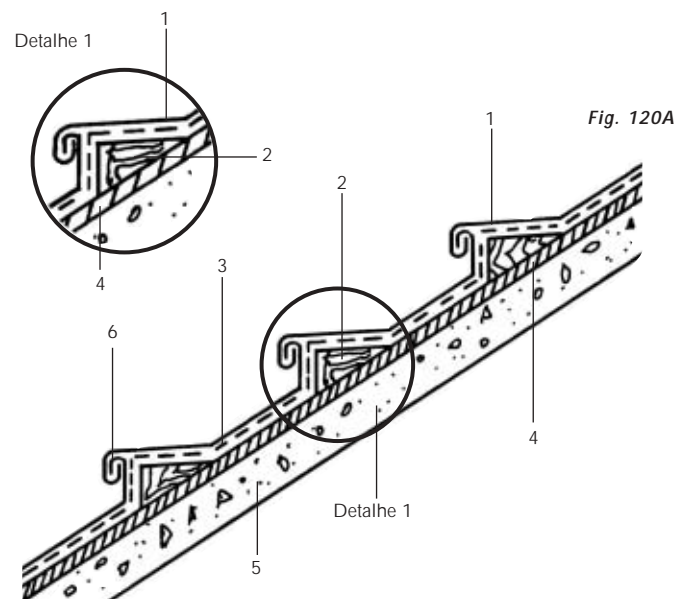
A - Detalhe - escalonamento com cunha de madeira.
